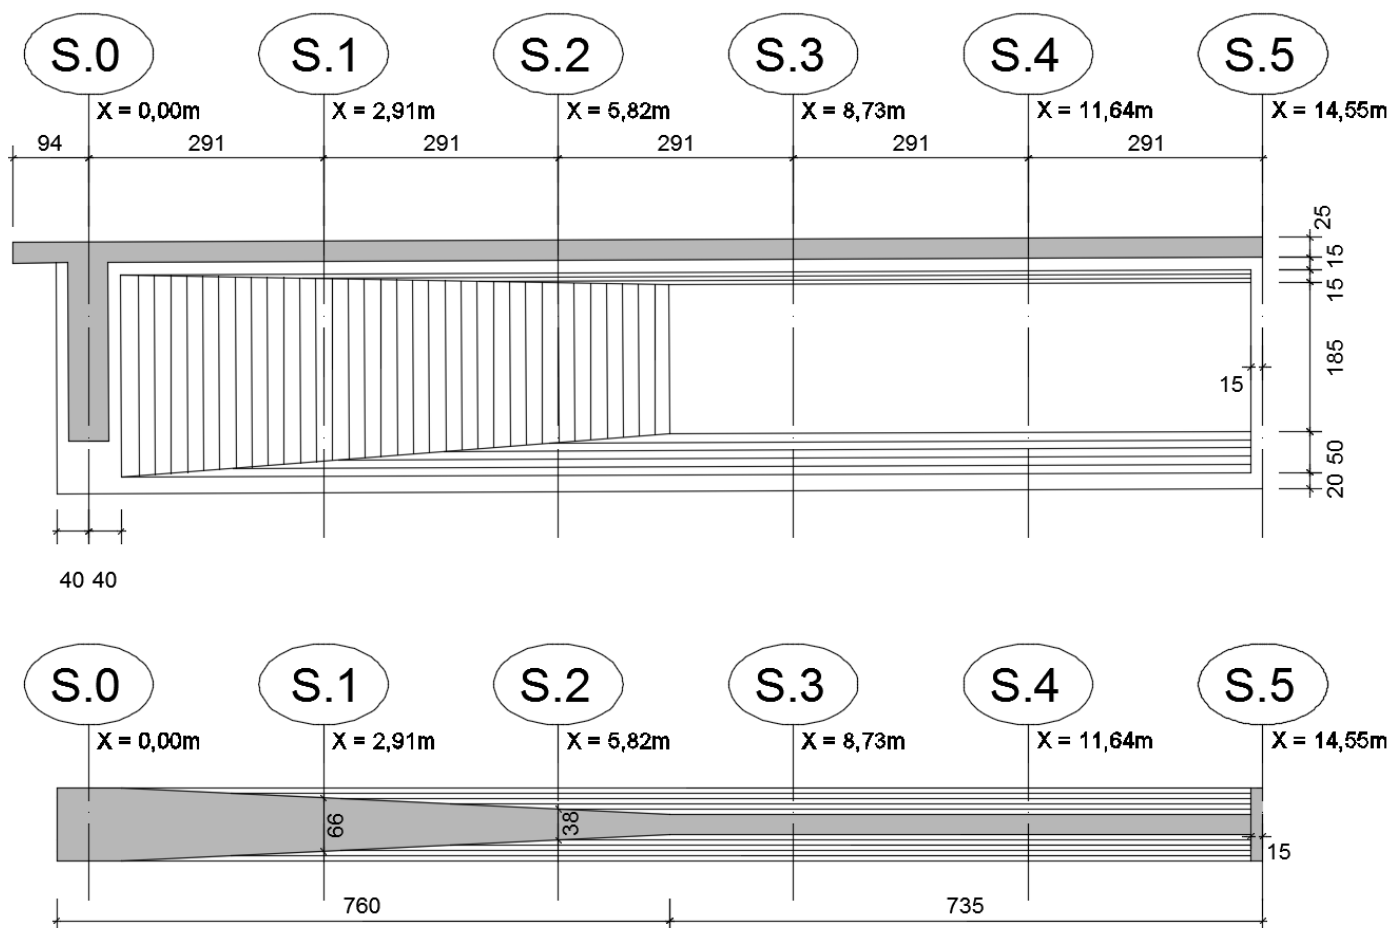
Elevação e Corte Horizontal da Viga Pré-Moldada
